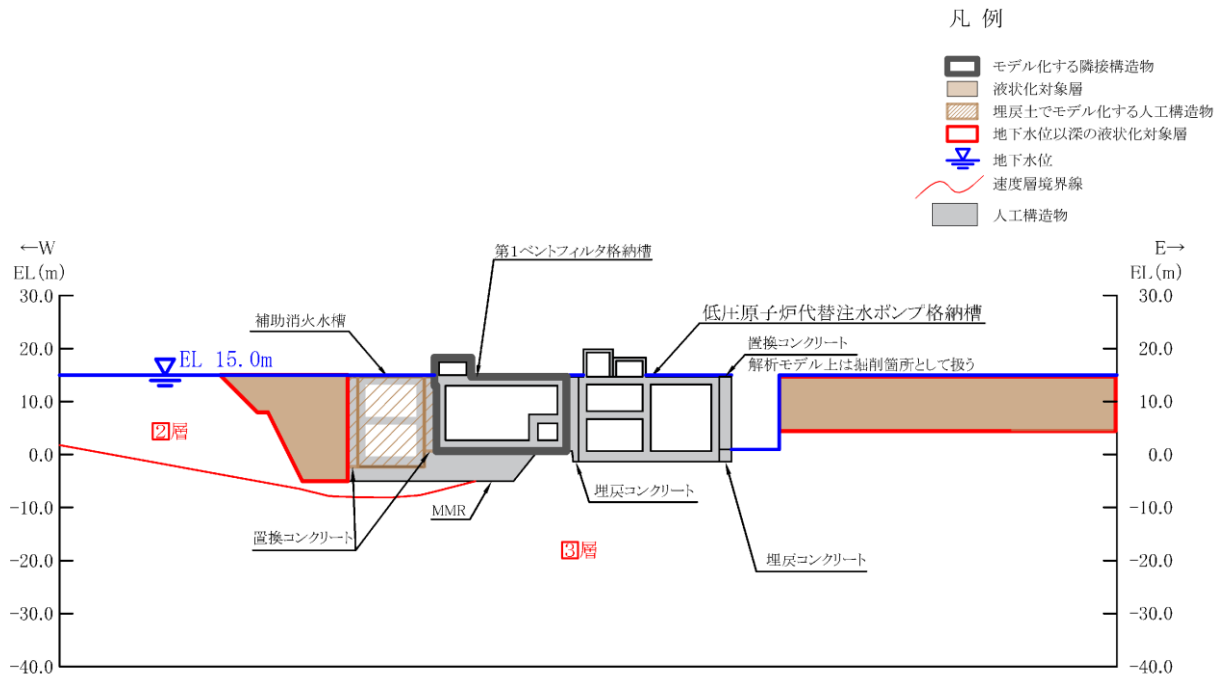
低圧原子炉代替注水ポンプ格納槽 評価対象断面図 (C-C 断面位置)
